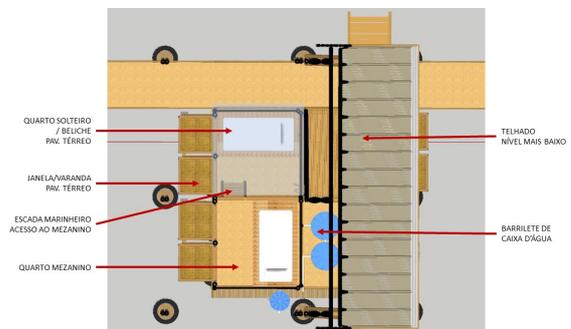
Planta baixa mostrando a adição de mezanino. Fonte: elaborada pelos autores.
